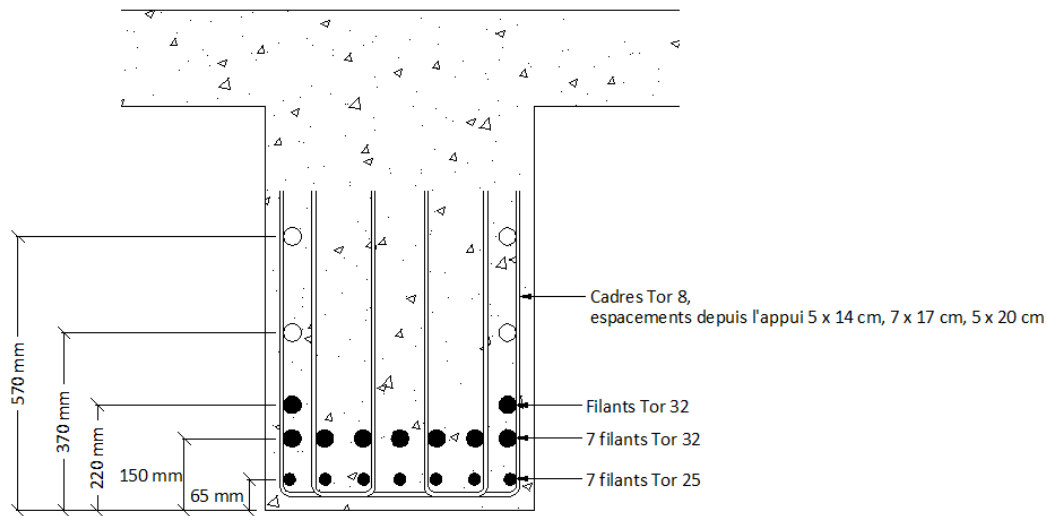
Ferrailage des poutres des travées intermédiaires
